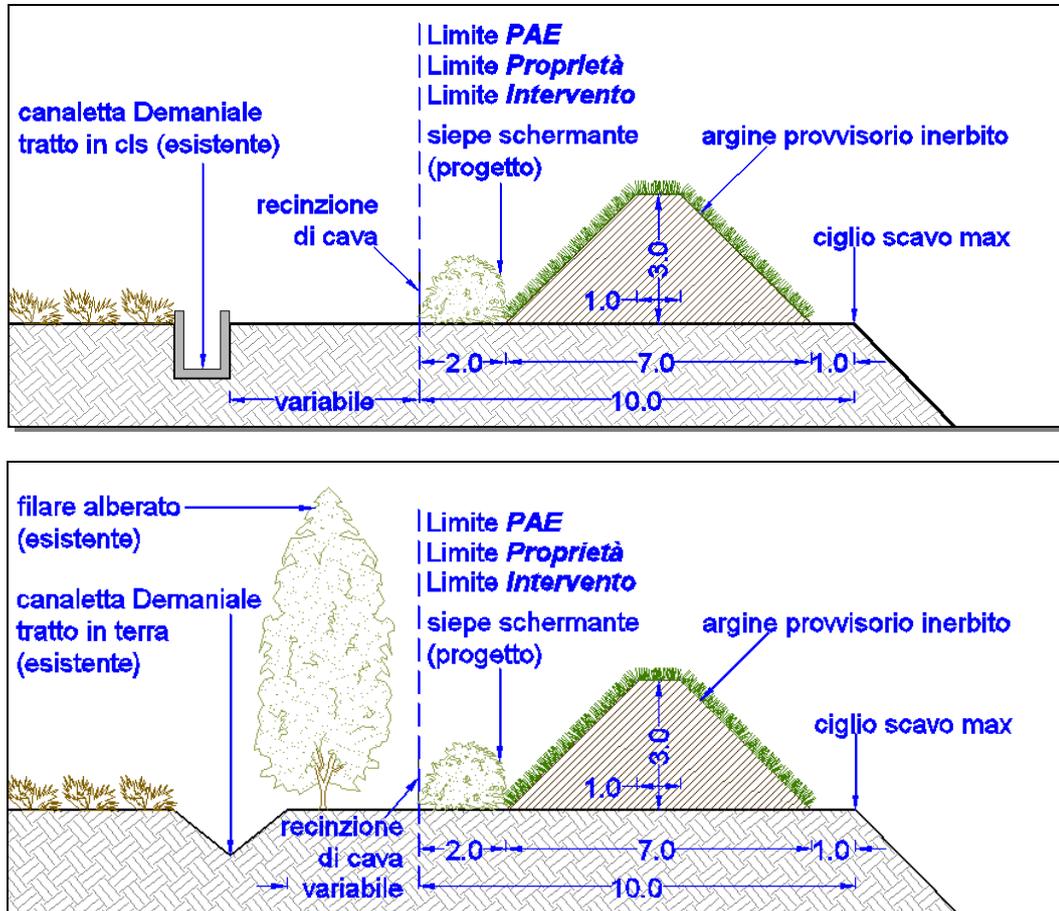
Arginatura perimetrale sul limite d'intervento ovest da porsi a mitigazione nei confronti di proprietà di terzi. (sopra) – limite ovest nel tratto sud in affaccio al manufatto idraulico. (sotto) – limite ovest nel tratto nord in affaccio al canale irriguo con fondo inciso in terra contornato dal filare di pioppi.
